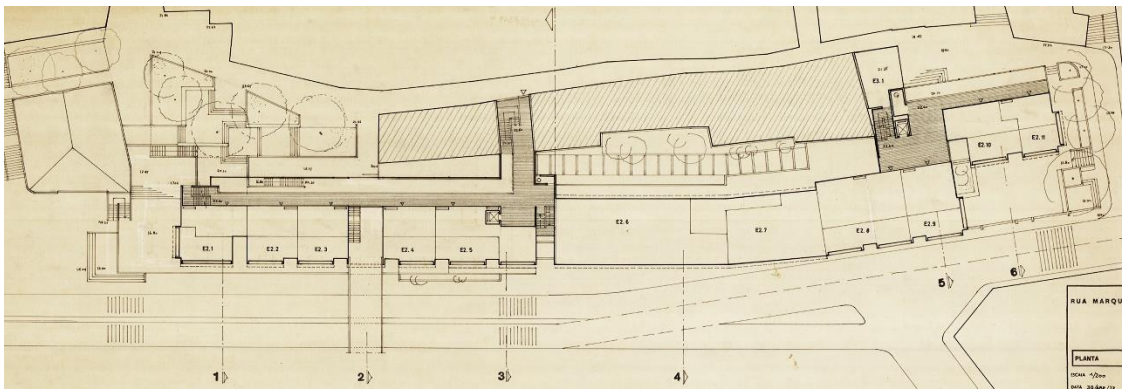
Planta do Piso 3, Estudo Prévio para a Rua do Marquês de Alegrete - EPUL, 30 de abril de 1973.
